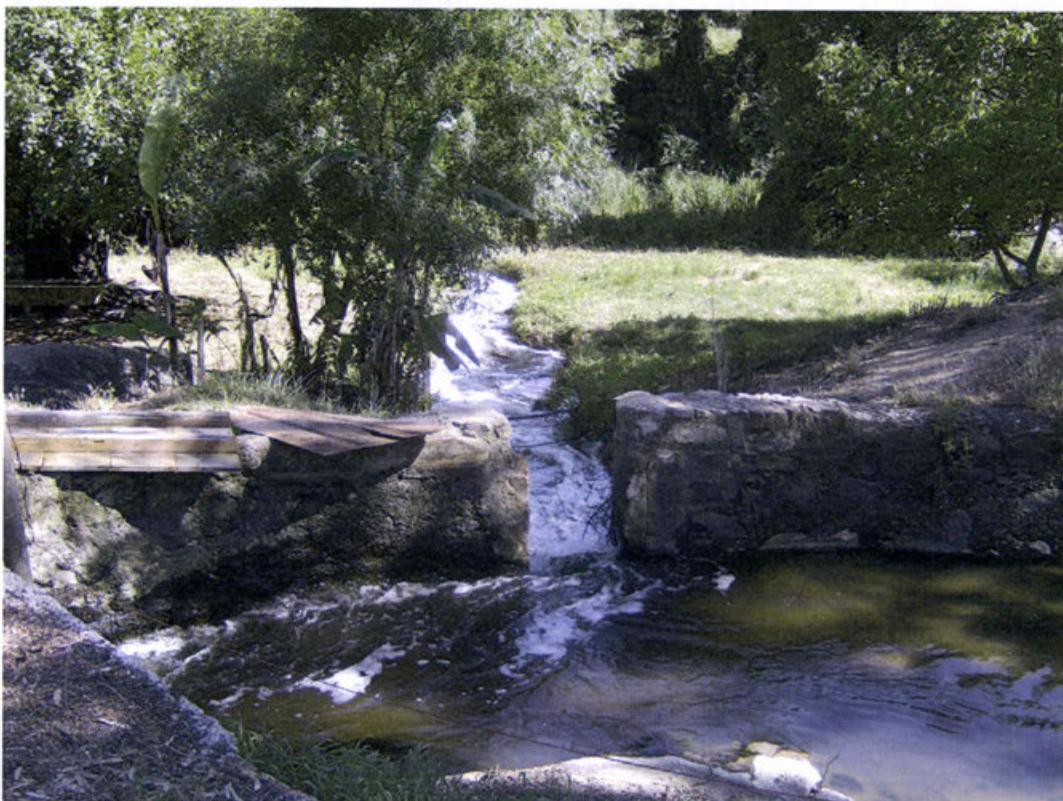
Foto da levada, pormenor da comporta s/tampa (ladrão)
